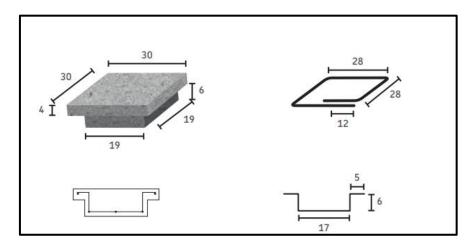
Detalle de los accesos de limpieza en las platabandas.
